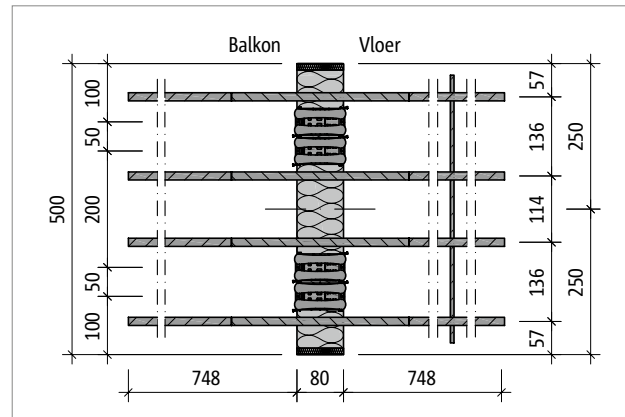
Schöck Isokorb® T type Q-E-V7: Bovenaanzicht
